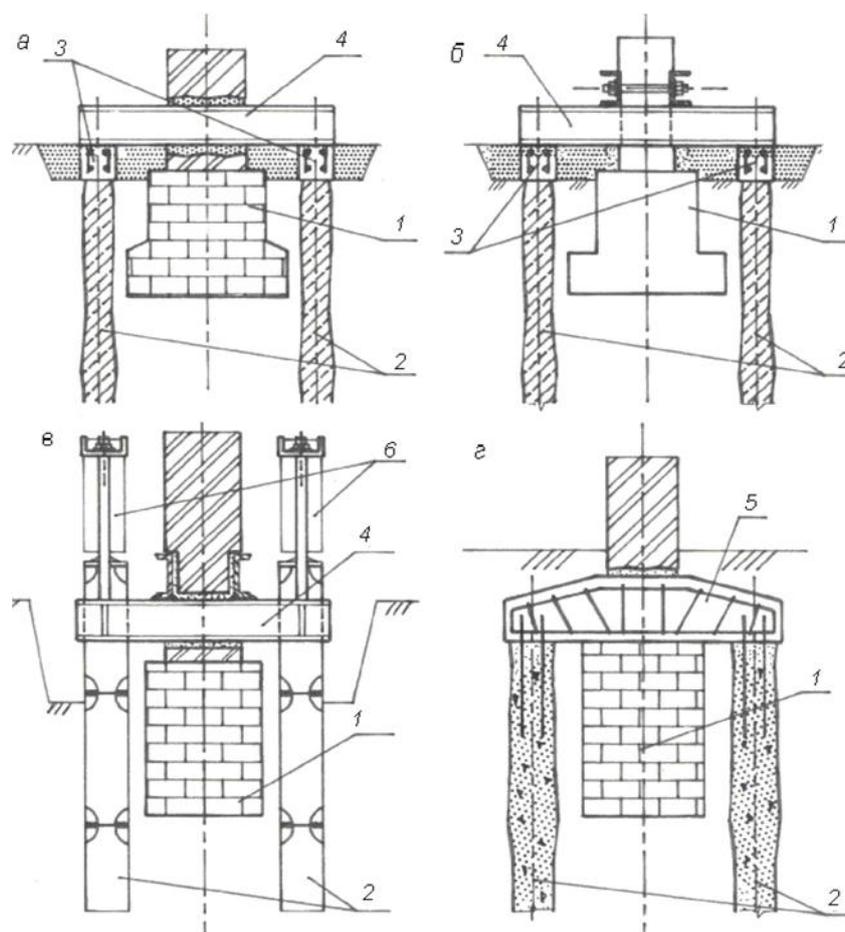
Усиление фундаментов сваями: а – ленточного фундамента; б – столбчатого фундамента; в – усиление многосекционными сваями; г – с применением железобетонной балки: 1 – существующий фундамент; 2 – сваи усиления; 3 – железобетонный ростверк; 4 – стальная балка; 5 – железобетонная балка; 6 – домкраты
